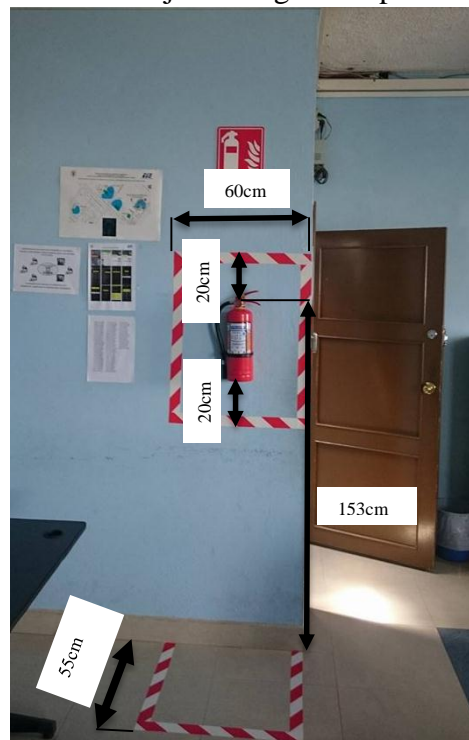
Ubicación de la alarma y del extintor y el área de protección en la planta alta
